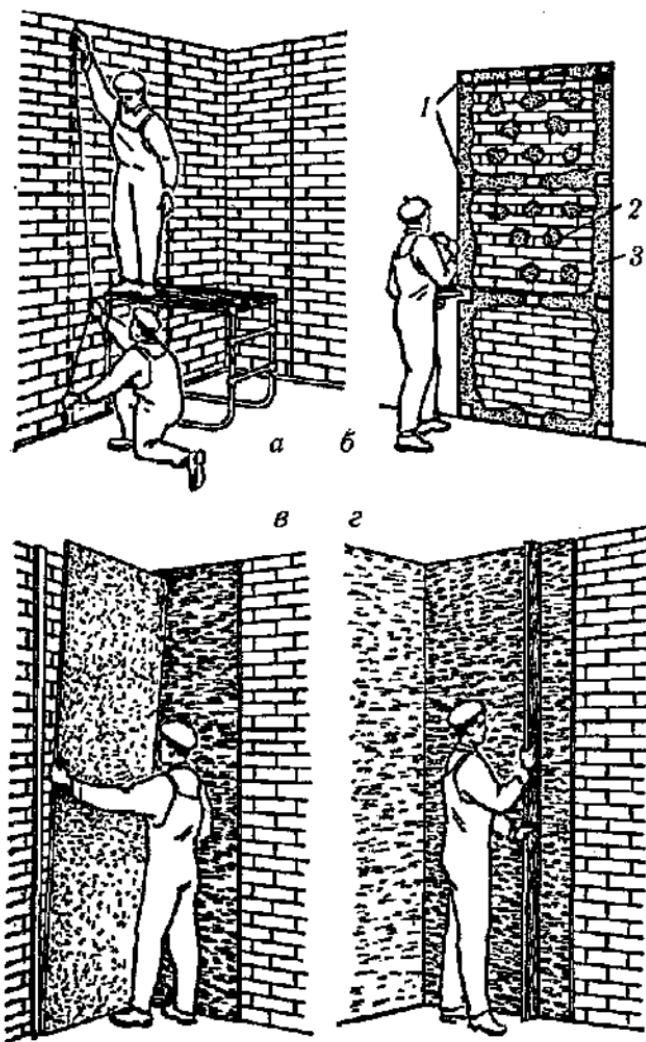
Облицовка гипсокартонными плитами: а — разбивка поверхности; б — устройство опорных марок, лепков и нанесение полос мастики; в — установка целых листов в углу; г — припрессовка приклеиваемого листа; 1 — опорные марки; 2 — лепки; 3 — полосы мастики.
